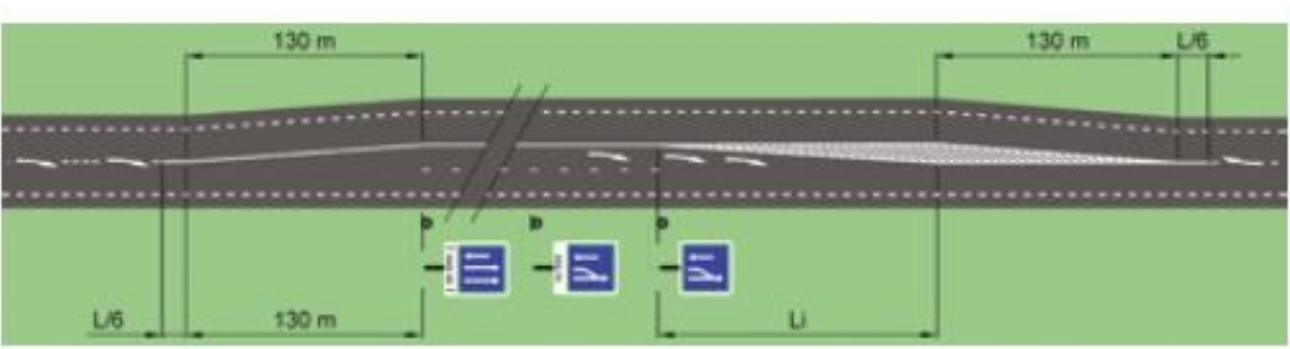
Sch ma de construction d'un cr neau de d passement – ARP 2022
